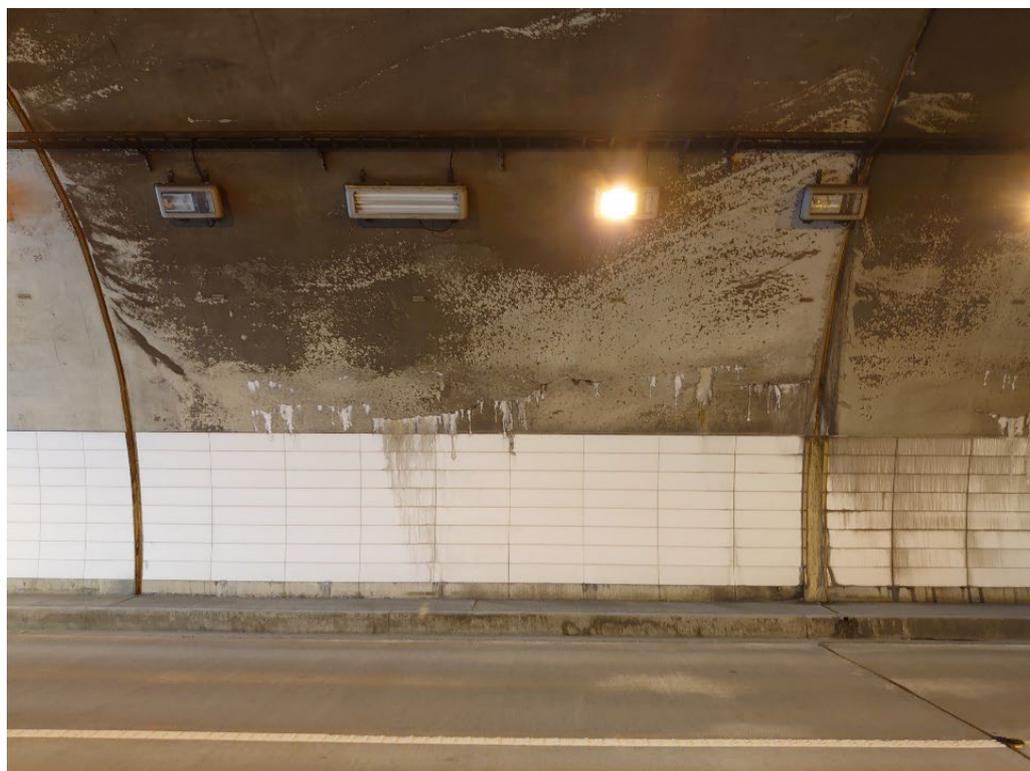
打重ね線に沿ったひび割れの事例
